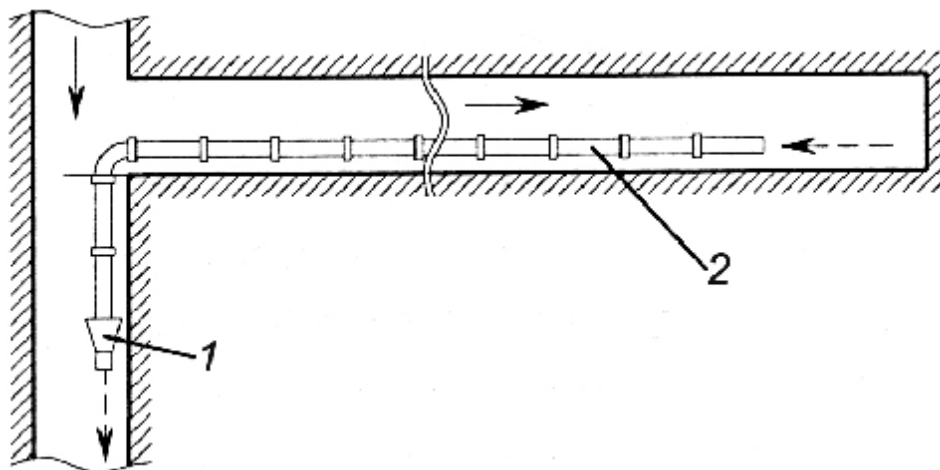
Схема всасывающего проветривания тупиковой выработки: 1 – всасывающий вентилятор; 2 – всасывающий трубопровод.
